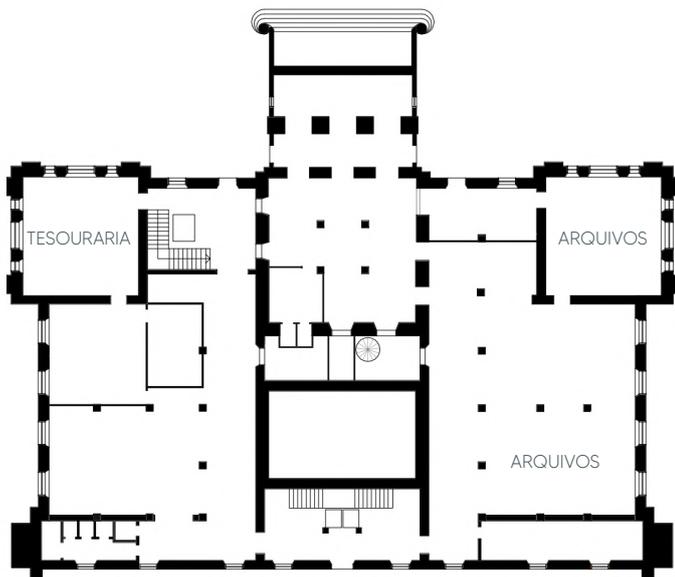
Redesenho planta do porão, Secretaria da Fazenda, 1942.
